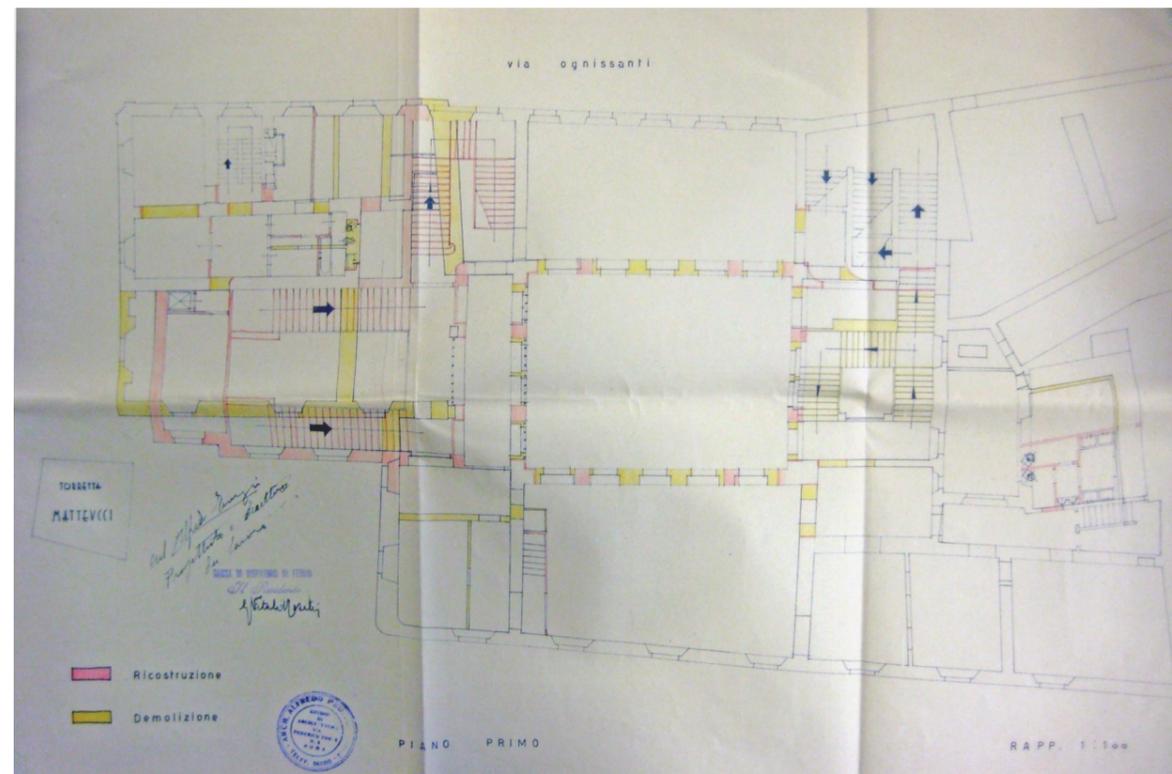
Pianta del piano primo. Progetto dell'architetto Alfredo Energici. Archivio della Cassa di Risparmio.
